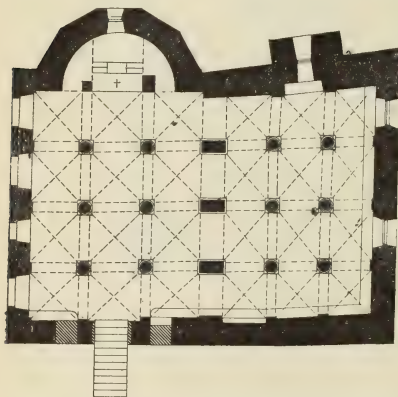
Zülpich, Kathol. Pfarrkirche. Grundriss der Krypta.
